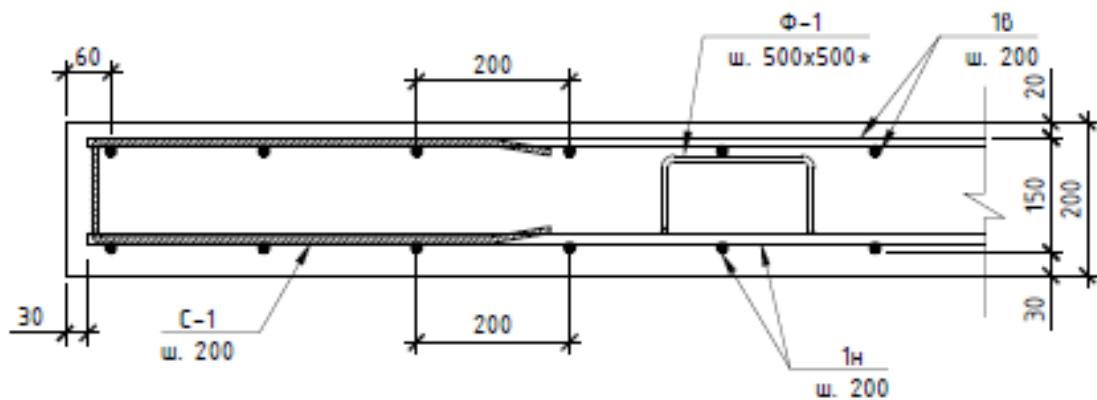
Шаг армирования плиты перекрытия (фрагмент проекта)
